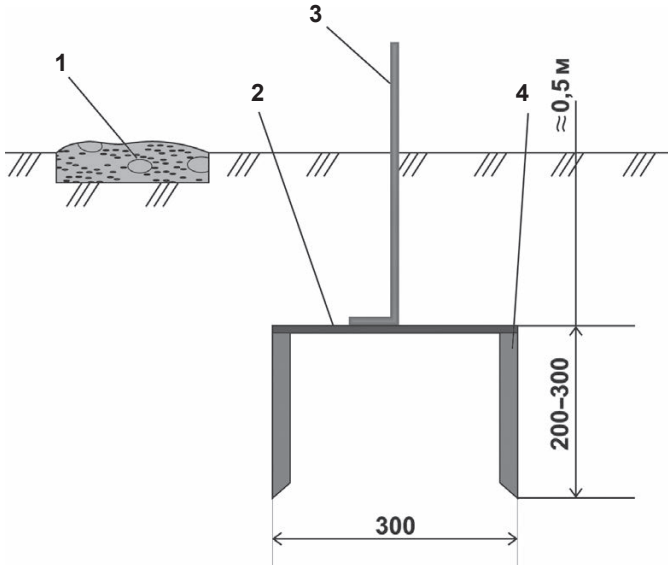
Вертикальный заземлитель (см): 1 — дорожка; 2 — поперечная шина; 3 — токоотвод; 4 — вертикальный стержень
